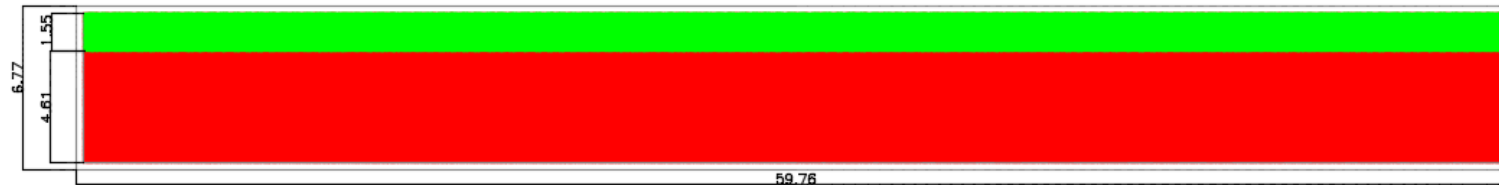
Vista en planta Drenaje sostenible Empresa productora de bienes de caucho
